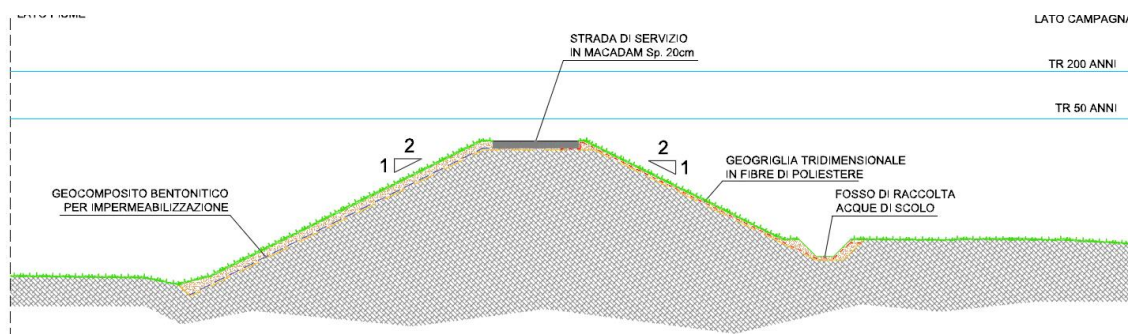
Sezione tipo impermeabilizzazione e rivestimento argine
